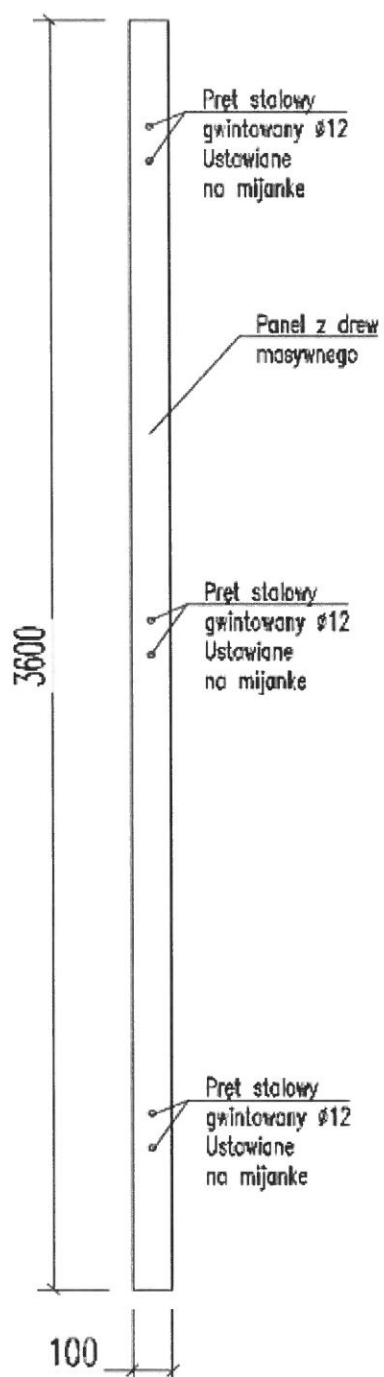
Konstrukcja elementu próbnego badanej ściany
